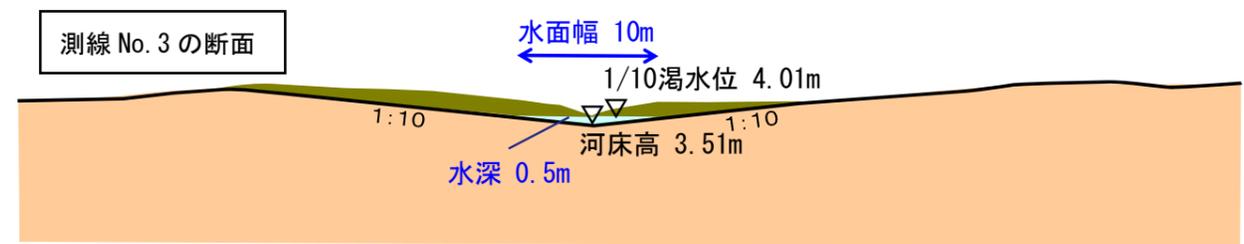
水ヶ曽根地区ワンドの計画断面図
